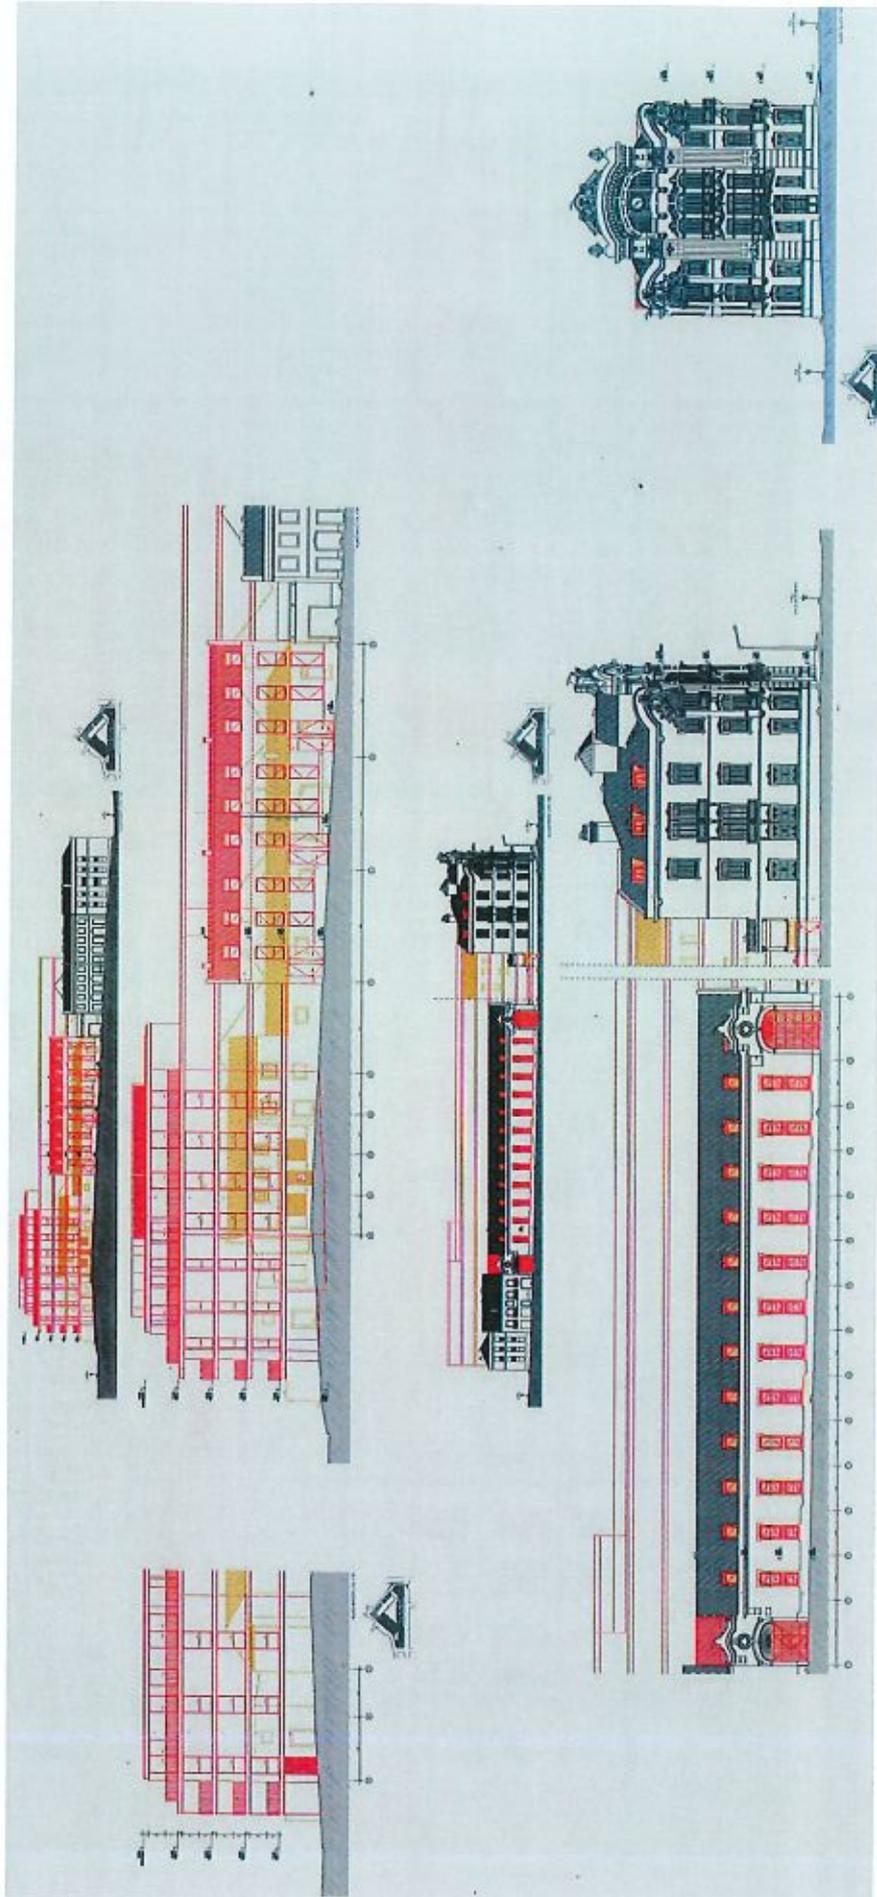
Desenho de Alterações/Cores Convençionais, Projeto de Licenciamento, fevereiro de 2021. Cortes e Alçados 2.03 AE – Alçado norte e poente, Rua Zófimo Pedroso.
